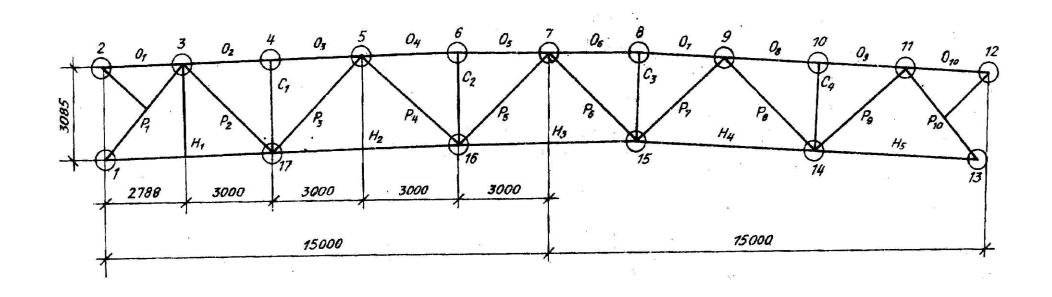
Геометрическая схема фермы ФС 30-6, 90 В; 2,50 В
